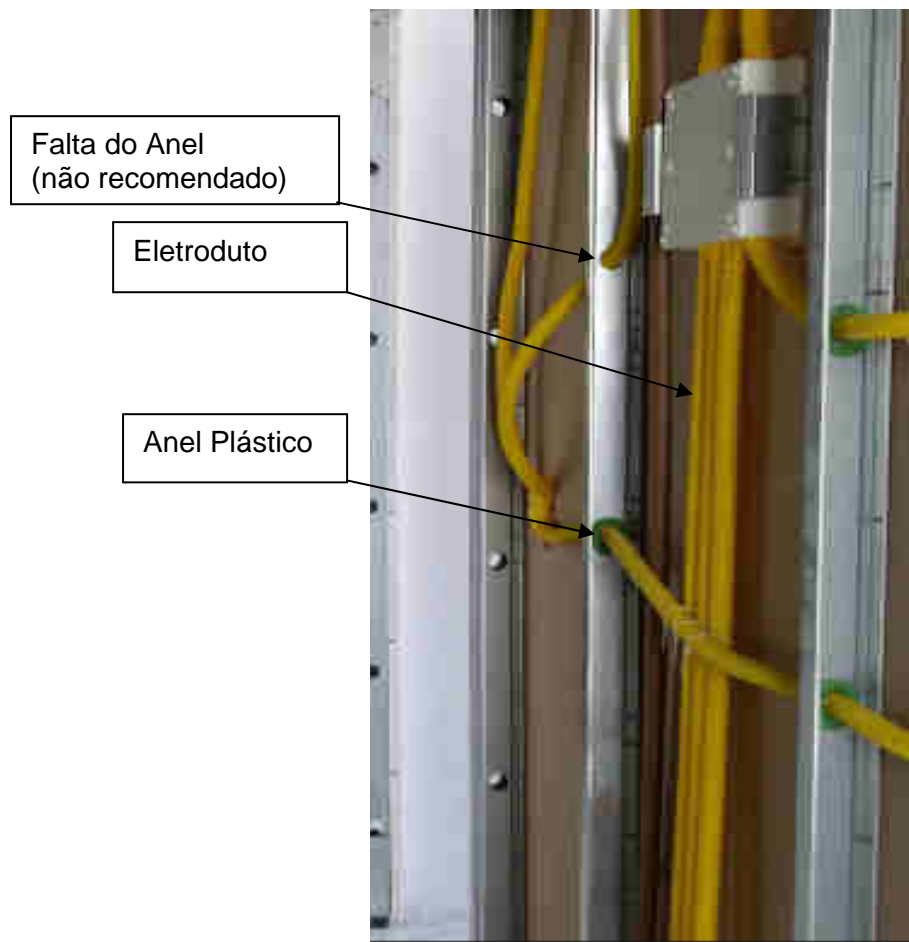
Estrutura metálica com proteção para eletroduto (Associação Brasileira do Drywall, 2016)
